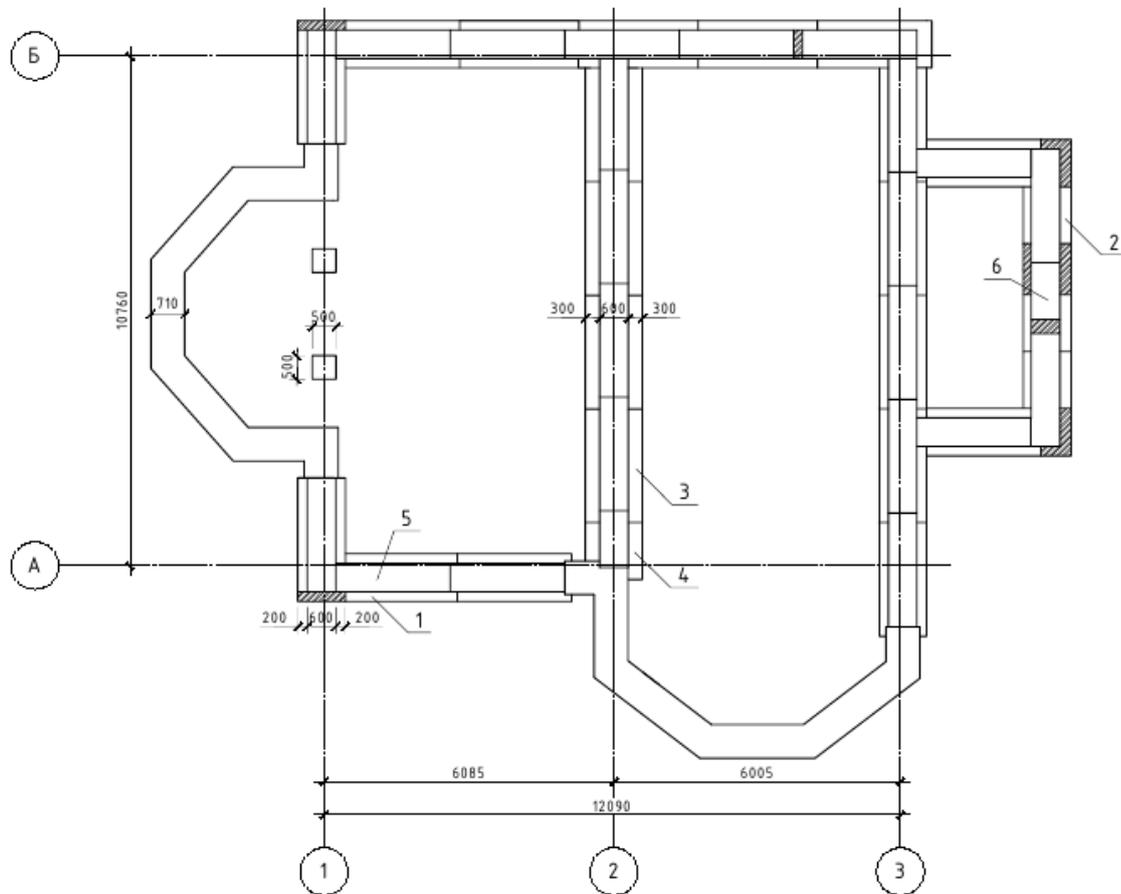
Пример оформления схемы расположения элементов фундаментов малоэтажного жилого дома
